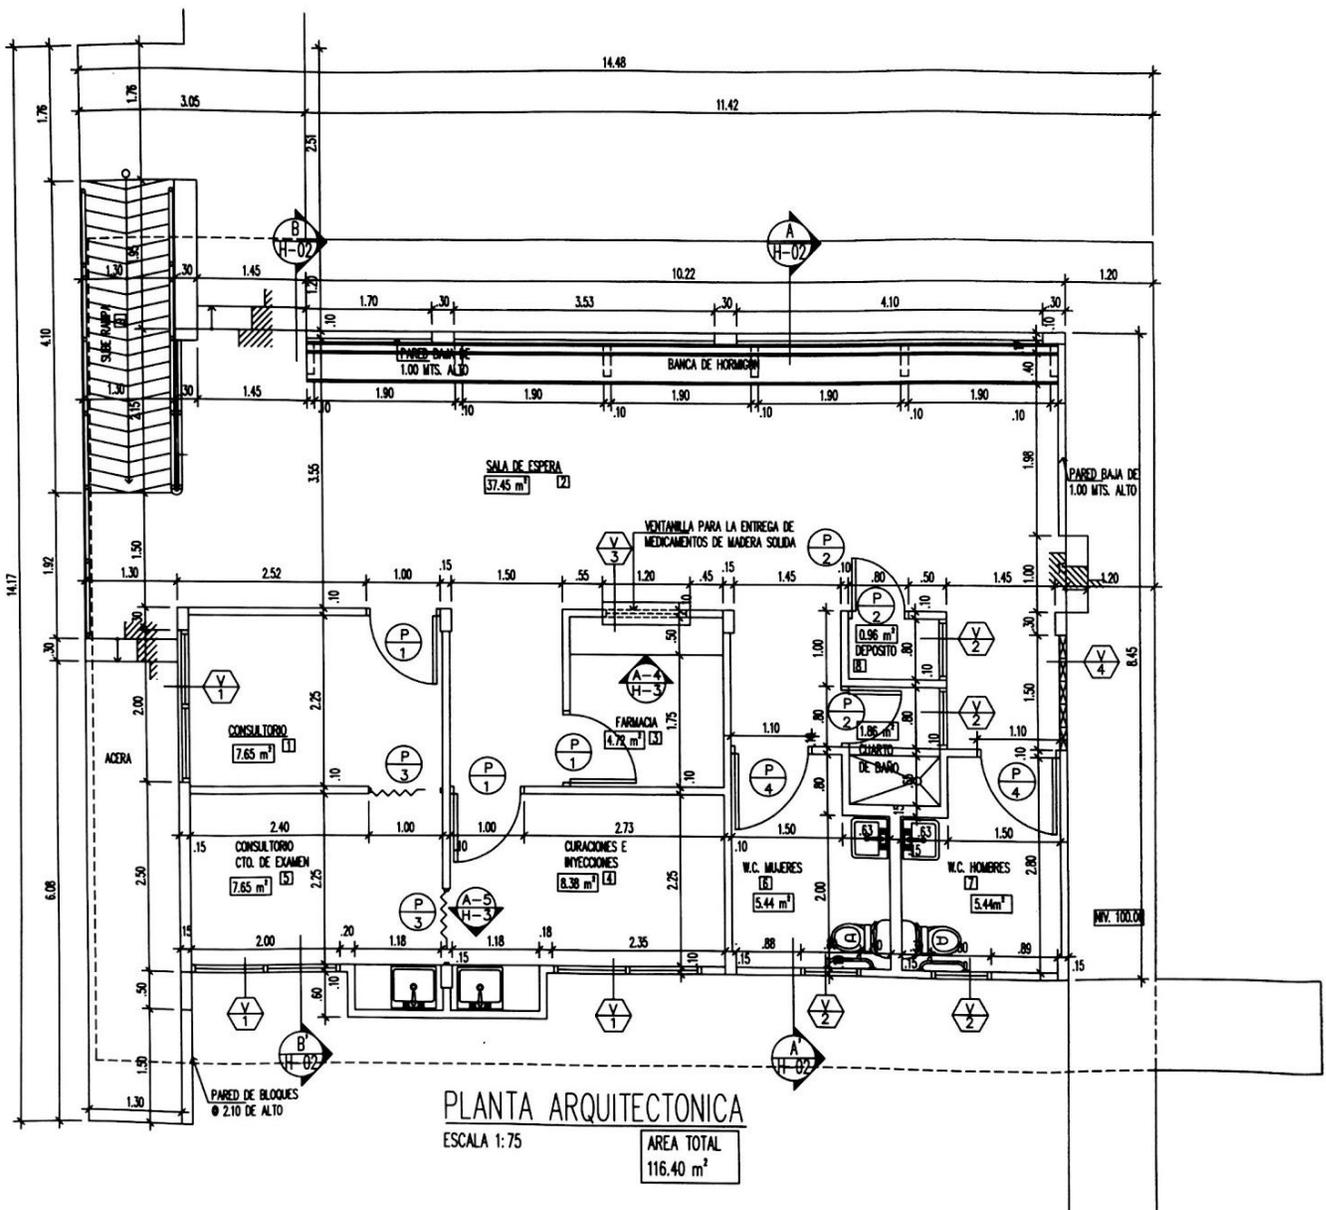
Ejemplo de planta arquitectónica de Puesto de Salud del MINSA.
